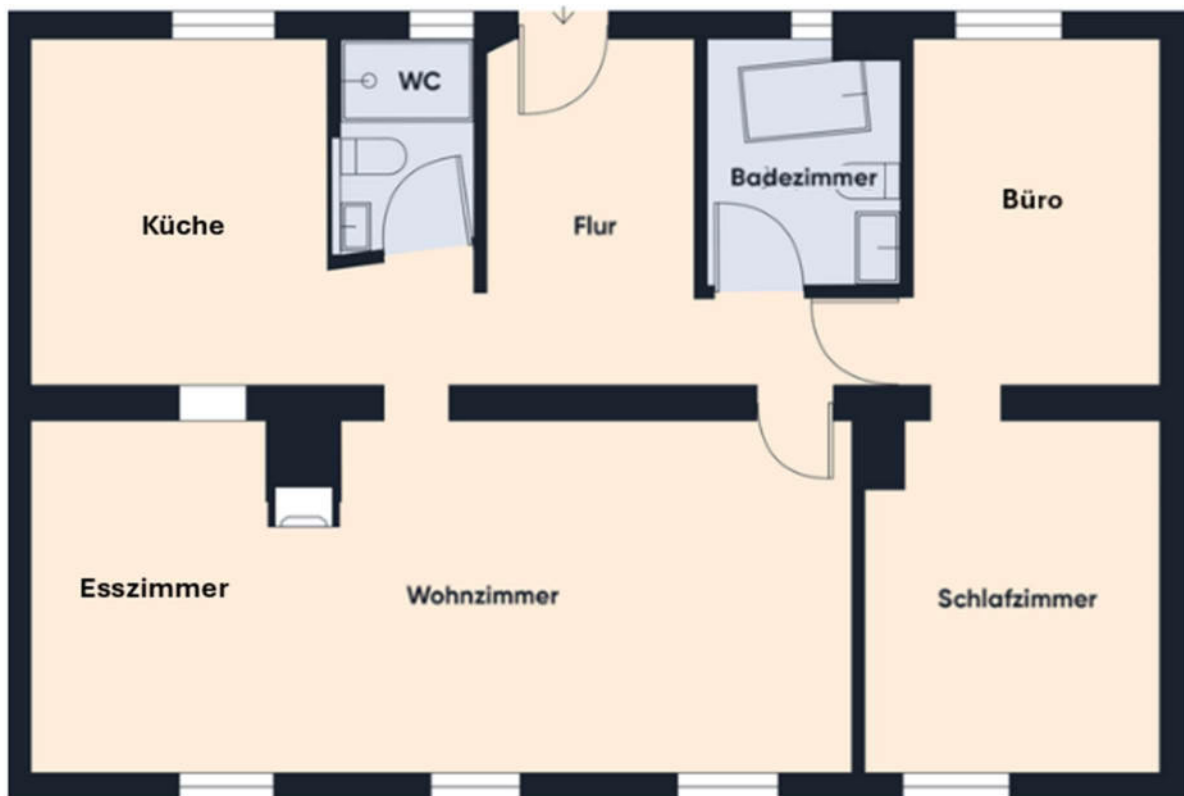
Grundriss 1. Obergeschoss
